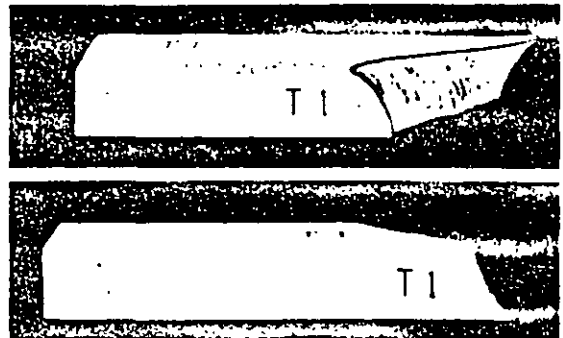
Viga de mortero simple en torsión pura (a) Vista superior ; (b) Vista inferior
